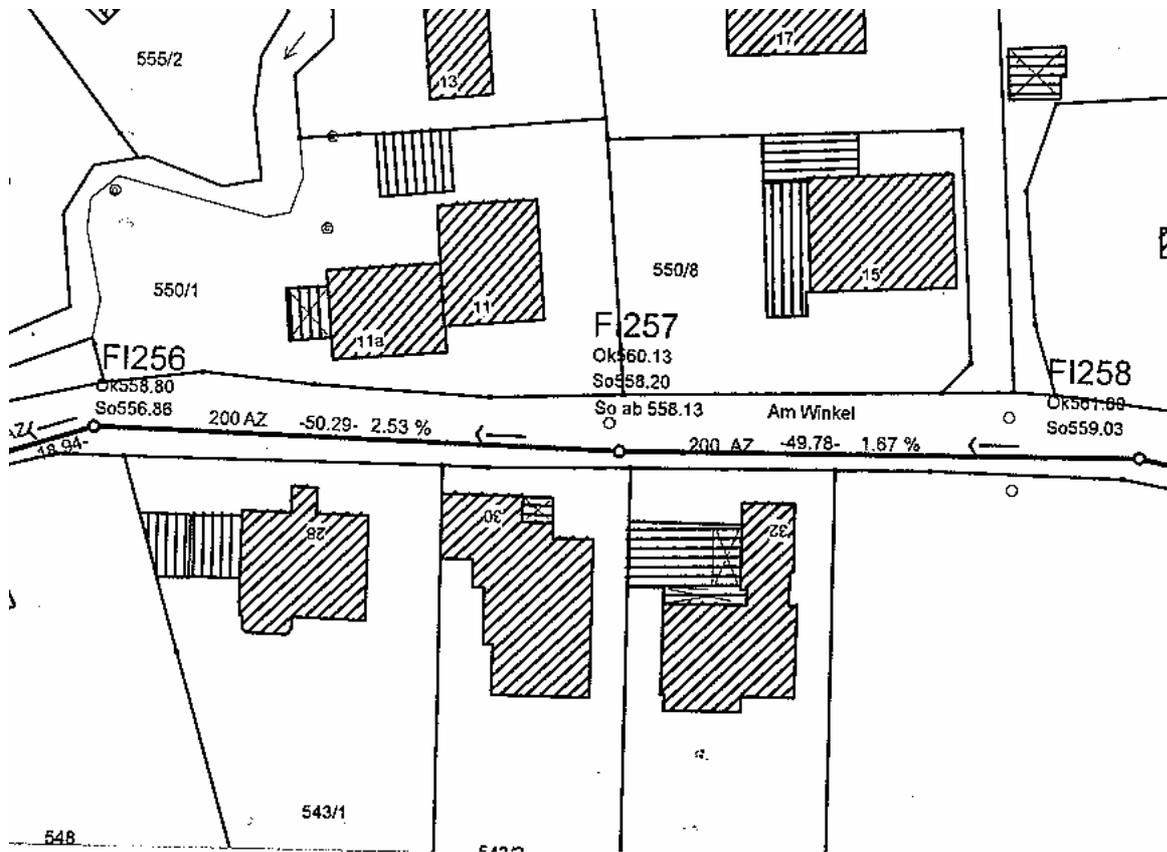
Lageplan im Maßstab 1:1.000 (gemäß Anhang 3)
